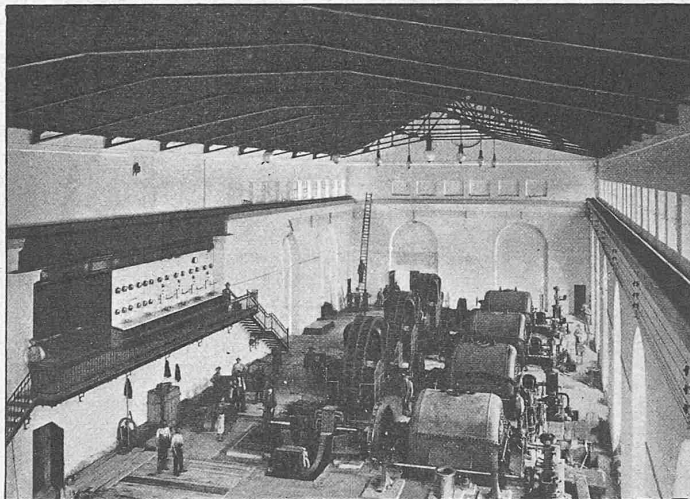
Ansicht des Maschinensaals in Paderno während der Montage.
